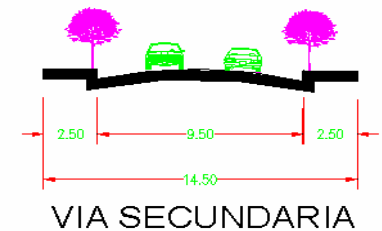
Propuesta de Vialidad en la sección de la carretera hacia la Hacienda
